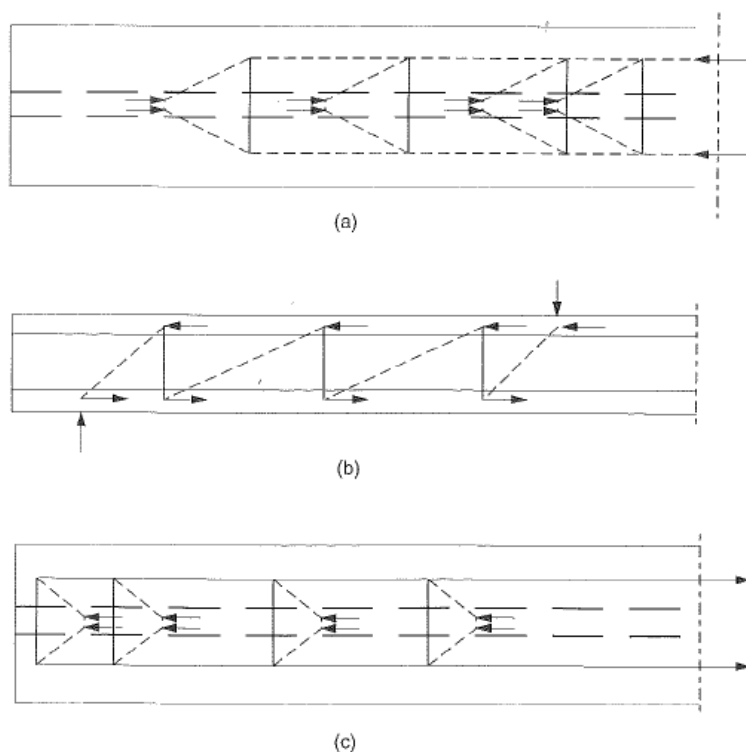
Modelos de una armadura para una viga en doble T
